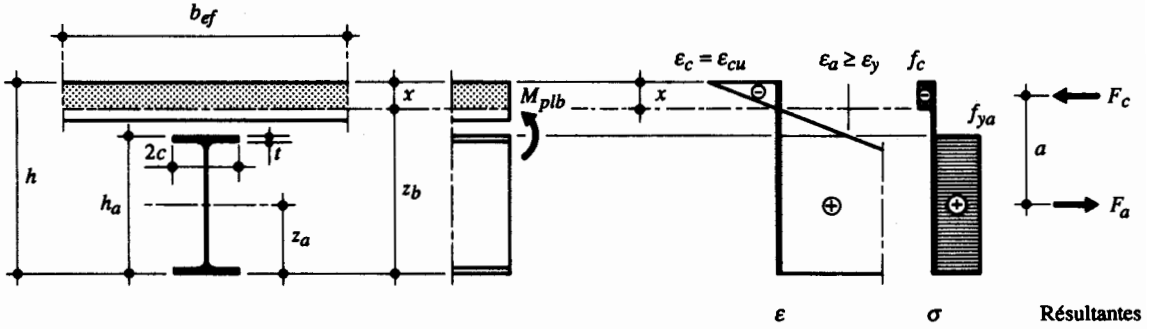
Section de poutre mixte en travée (calcul plastique).
